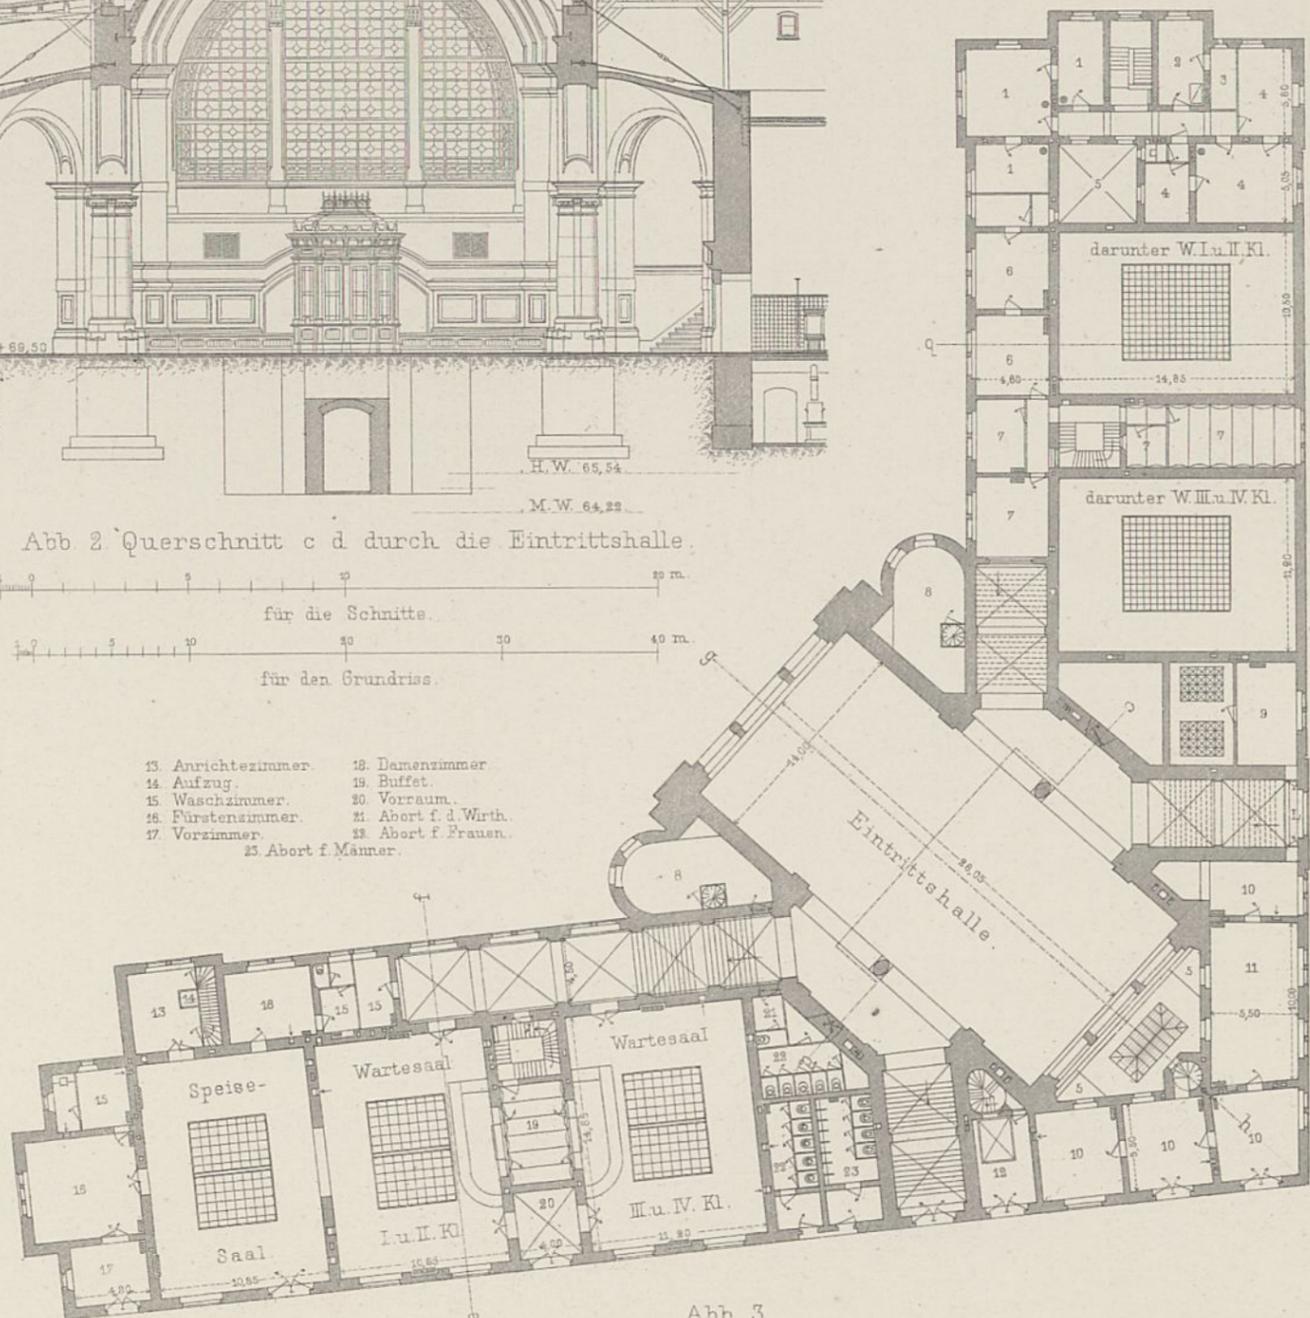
Grundriss in Höhe des Bremer Bahnsteiges.
